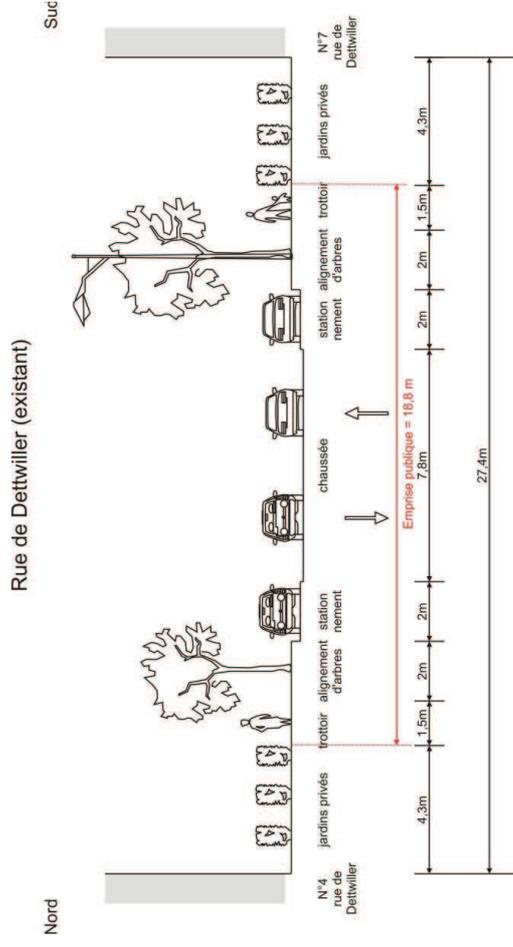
Situation existante (coupe 33) rue de Dettwiller
